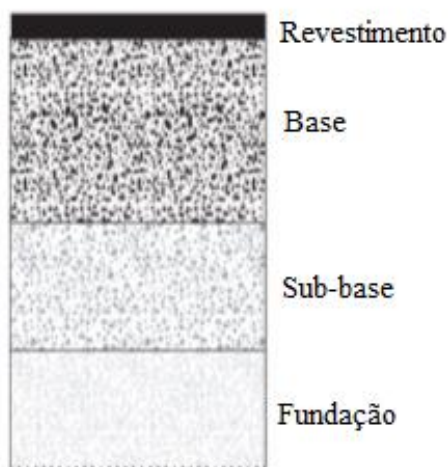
Estrutura do pavimento de uma EBVT. (Adaptado SATCC, 2003).
